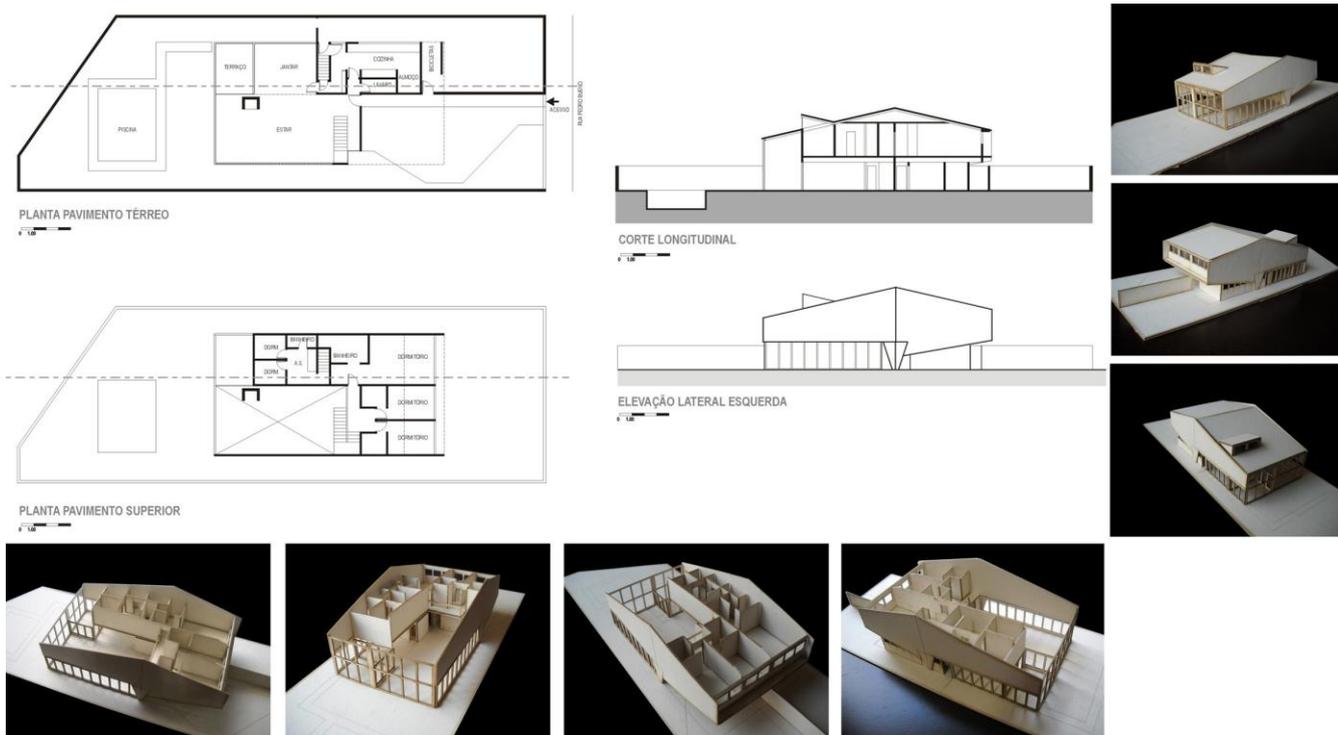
Planta, corte e elevação projeto para residência Elias e Dona Maná, 1981. Fonte: Re-desenho da autora, 2010. Fabricação e fotos da maquete. Fonte: Autora, 2010.
